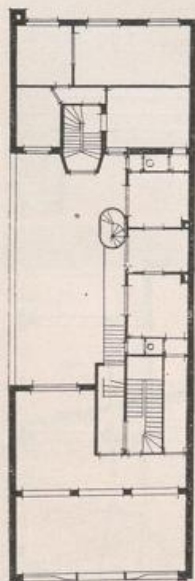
Schadowstrasse 47. Obergeschoss. 1:500.
